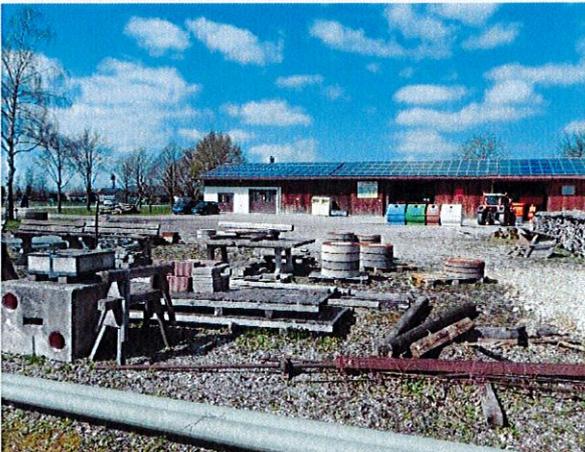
Lagerflächen des Bauhofs (Blick nach Norden)
